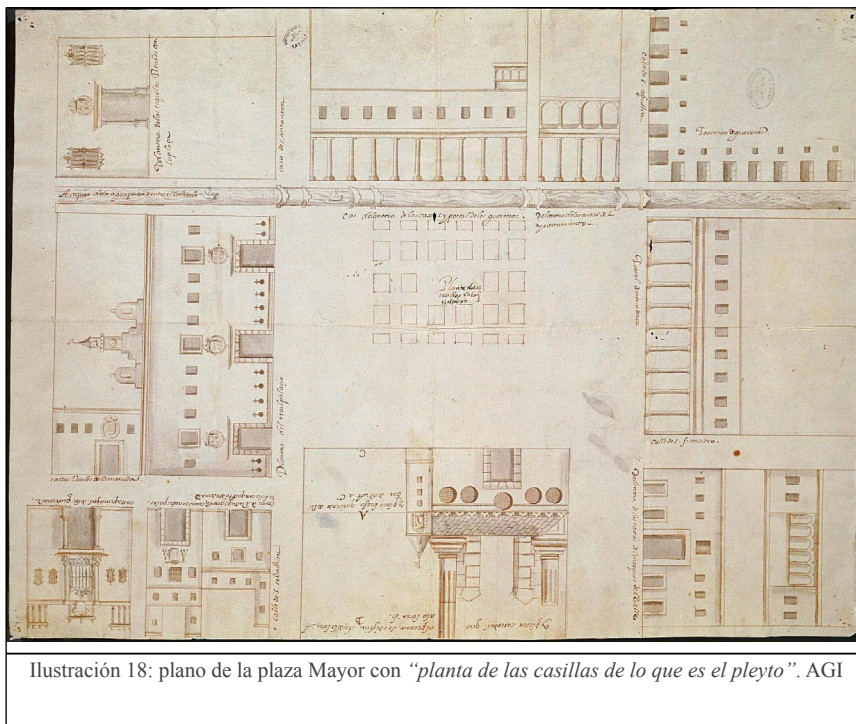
plano de la plaza Mayor con “planta de las casillas de lo que es el pleyto”. AGI
